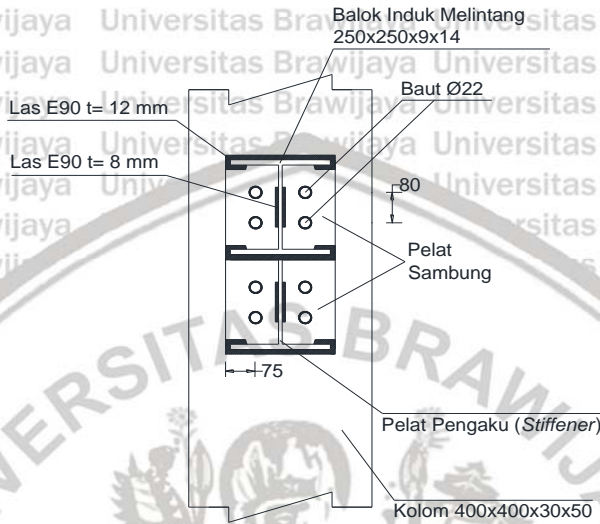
42 Tampak Atas Sambungan Balok Induk Melintang ó Kolom
